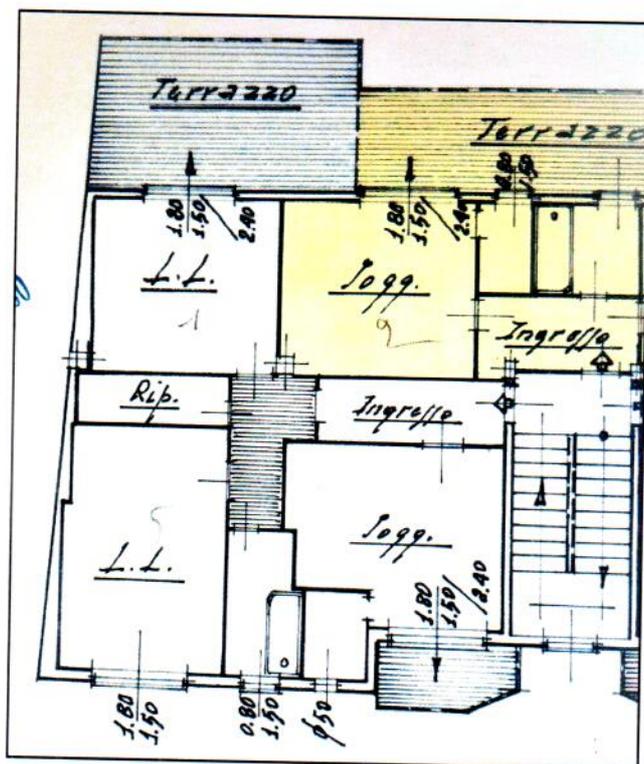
Planimetria allegata all'autorizzazione Edilizia n.13/60 dell'11.03.1960
